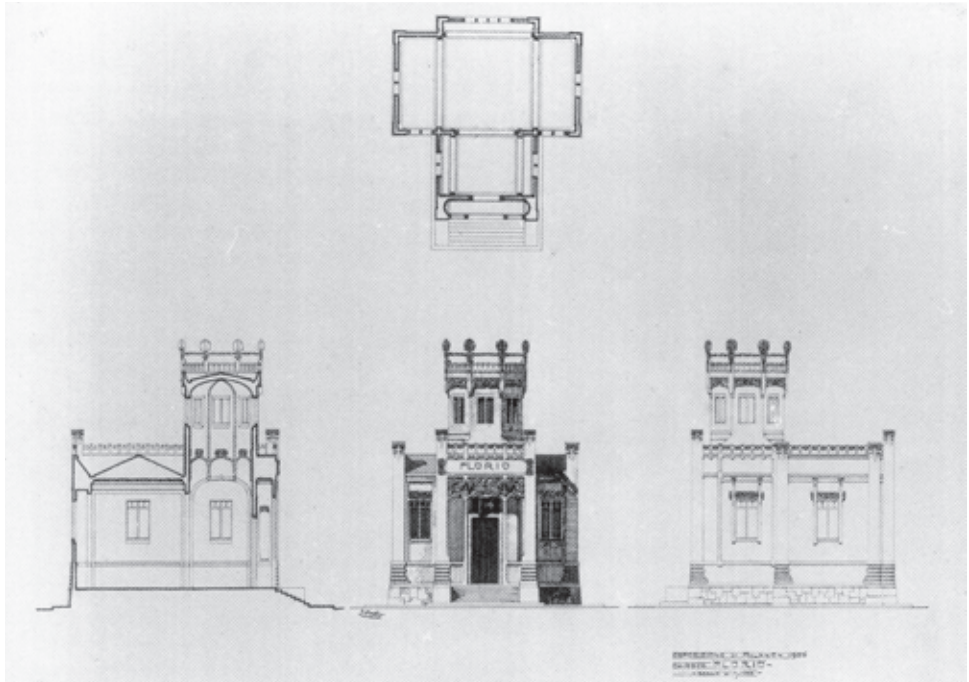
Padiglione Florio all'Esposizione Internazionale del Sempione, Milano. Ernesto Basile, 1906. Pianta, prospetto principale, sezione longitudinale, sezione trasversale (Dotazione Basile, Palermo).
